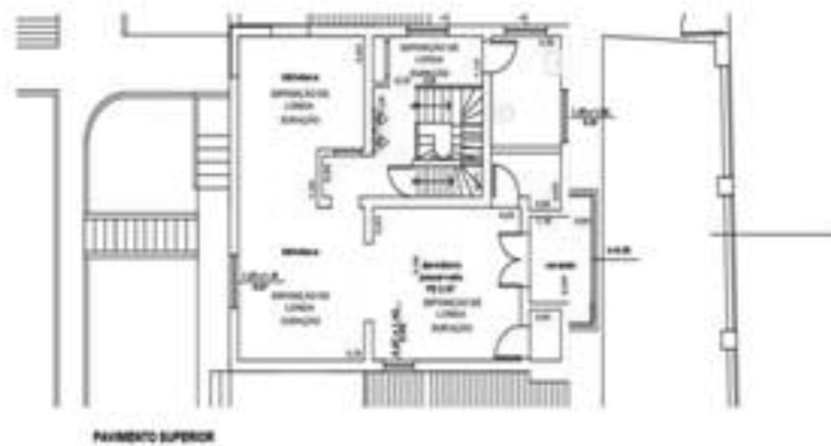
Planta baixa piso superior do Museu Casa Guilherme de Almeida. Plano Museológico (2018)
